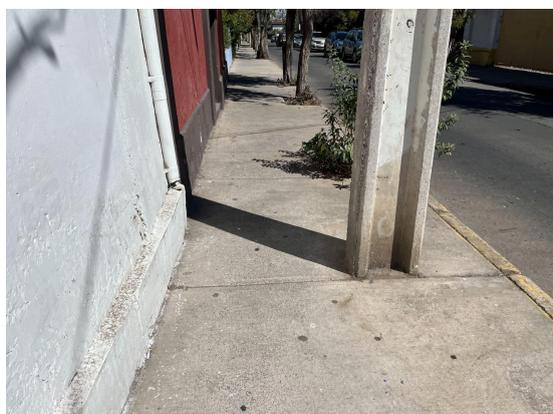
Ruta accesible en calle menor interrumpida por poste.
